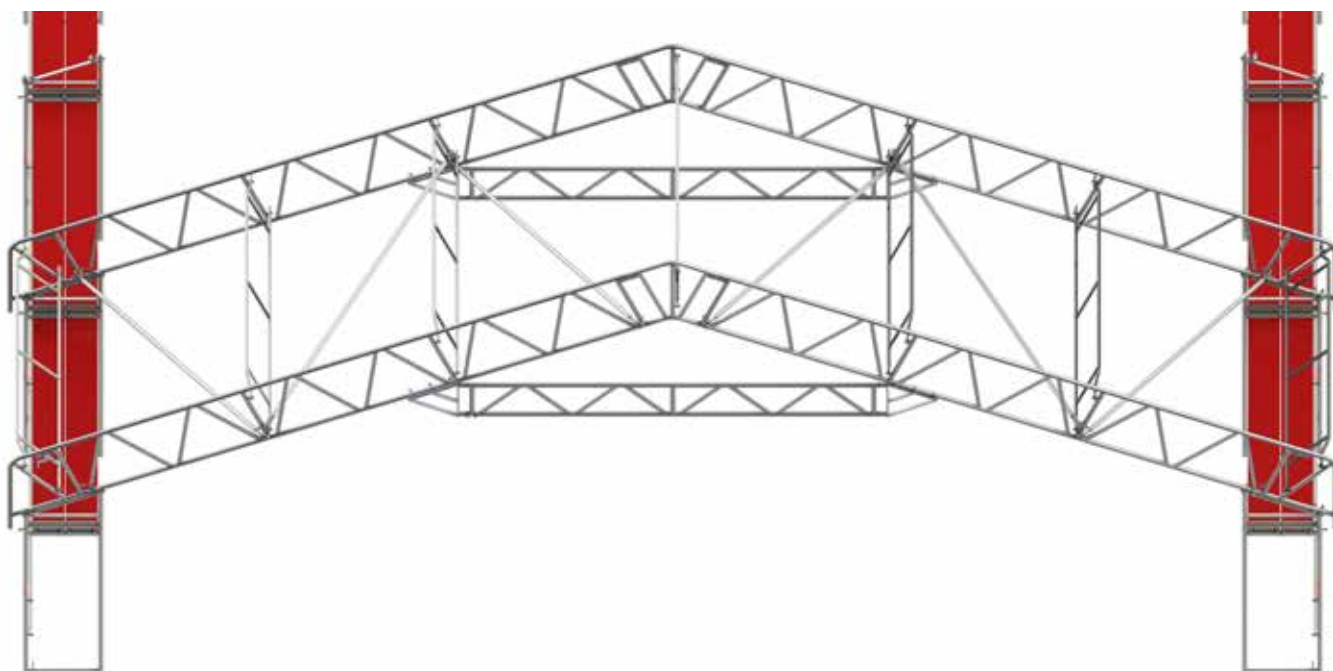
Połączenie pierwszego przęsła dachowego z rusztowaniem.
